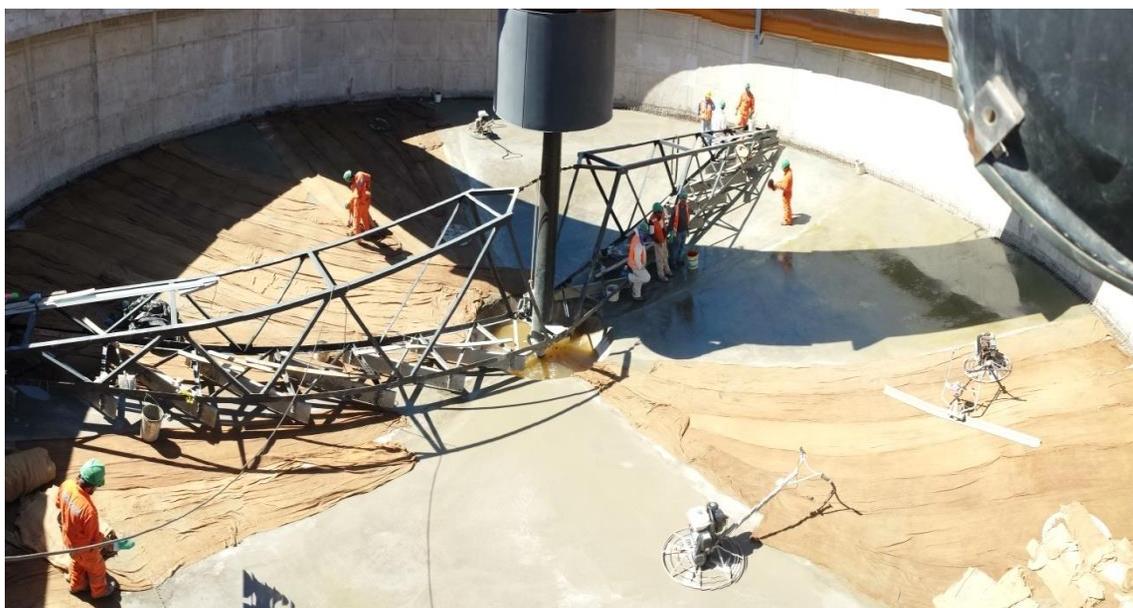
Alisado e inicio de curado de la losa(fuente: foto tomada durante la práctica)
